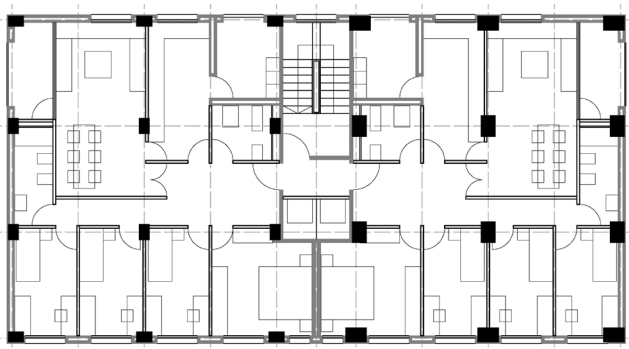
Dimensiones de pilares en edificios residenciales de 5 plantas proyectados según EC8 para sismicidad y ductilidad altas, con vigas de canto (mitad izquierda) y vigas planas (mitad derecha).
